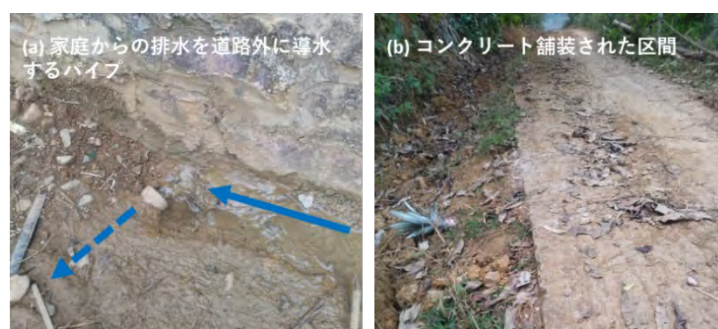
Rural Road に見られた排水施設と部分的なコンクリート舗装
